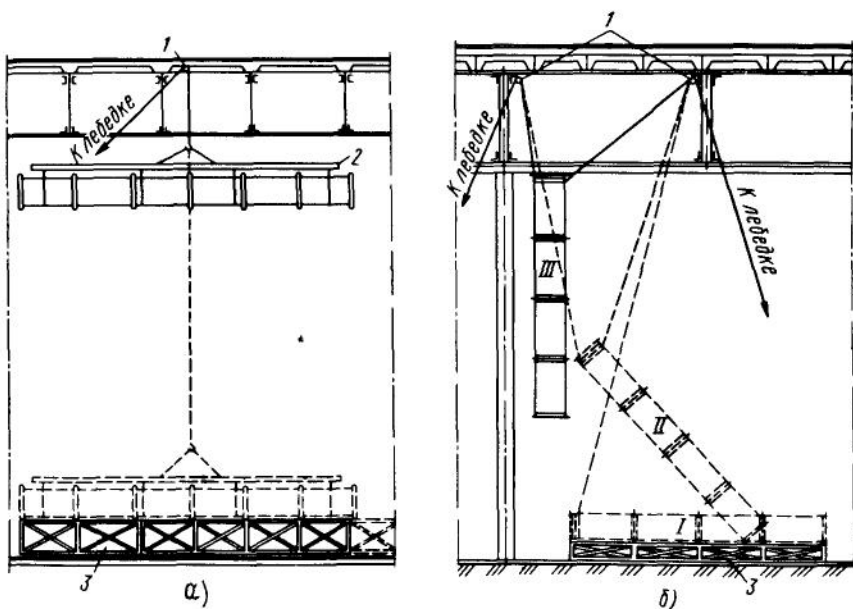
Монтаж воздуховодов с бесфланцевыми соединениями на рейках: *а* — горизонтальных, *б* — вертикальных; 1 — блок, 2 — траверса, 3 — монтажный стол; I...III — положения воздуховодов при монтаже
